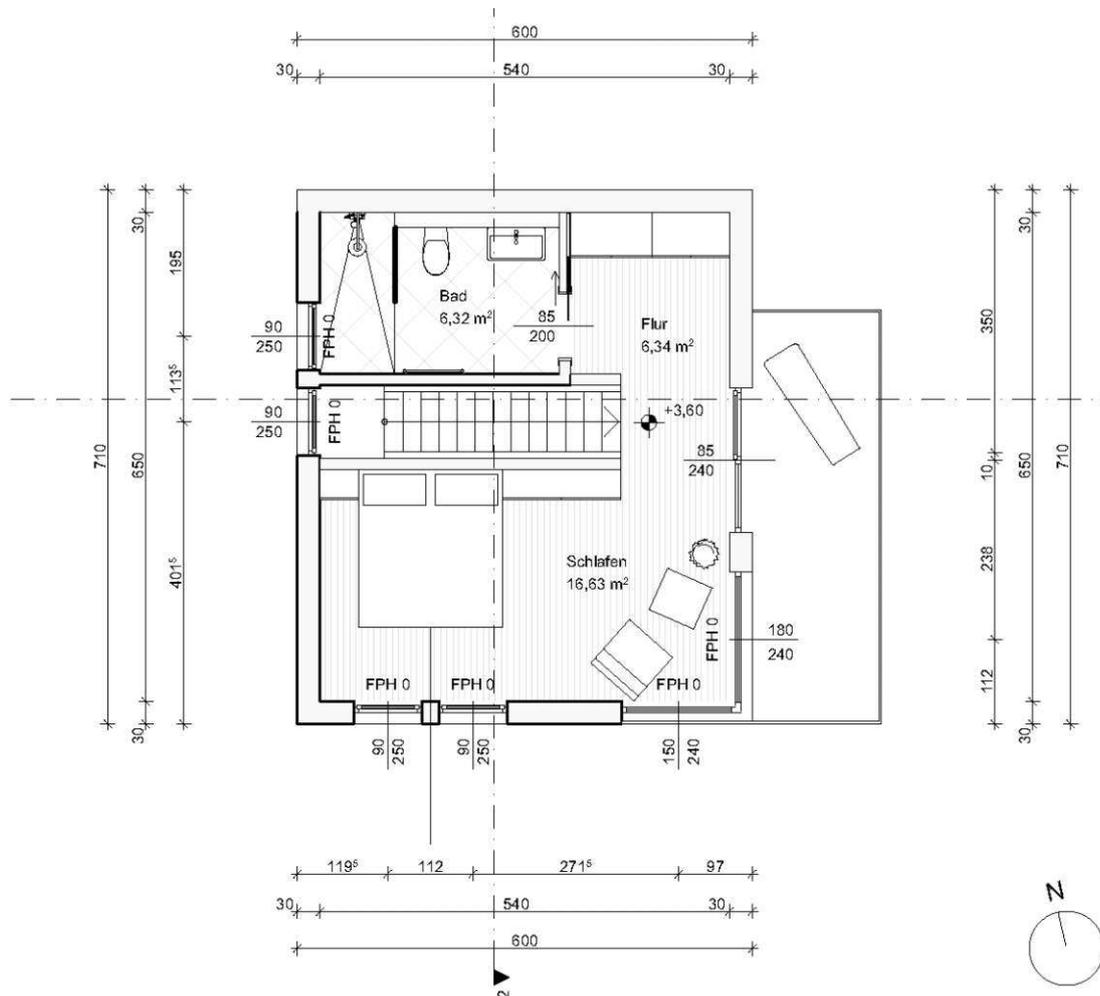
Grundriss Obergeschoß 1:100 (eigene Abbildung)
